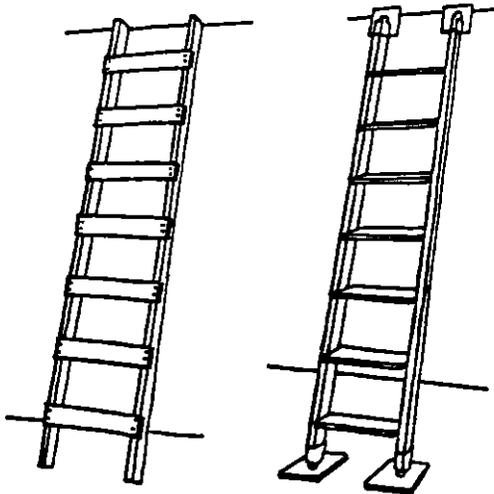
Échelle utilisée sur les chantiers de coffrage (à gauche).
